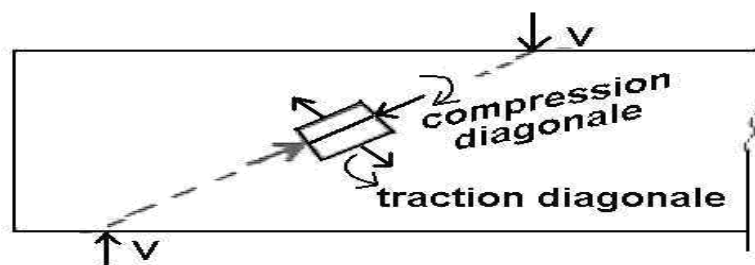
Comportement de fissuration diagonale dans une poutre sans armatures transversales [10]
